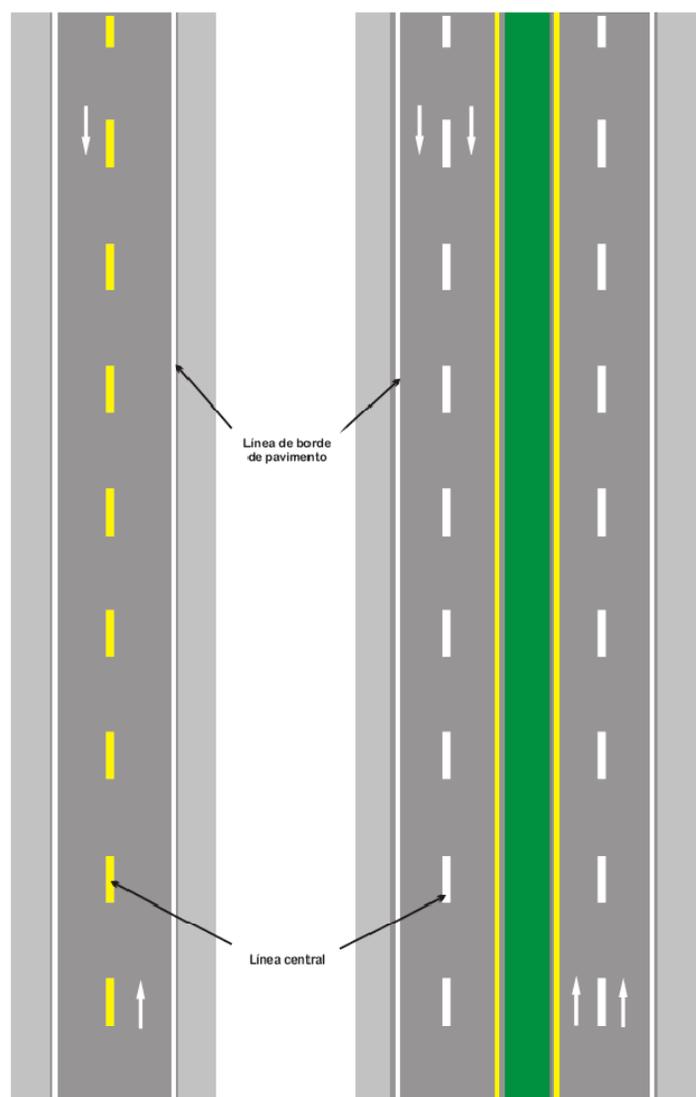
Líneas Centrales y de Borde de Pavimento.
